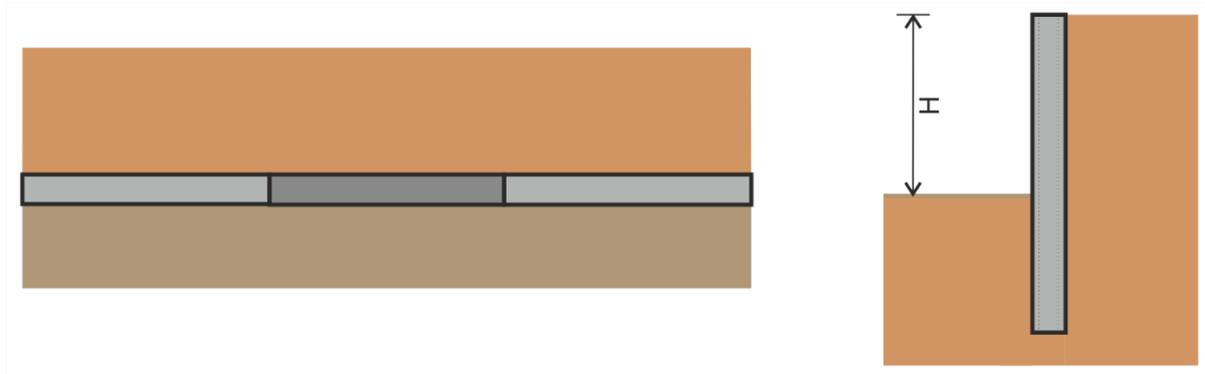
Grundriss und Schnitt einer Schlitzwand
